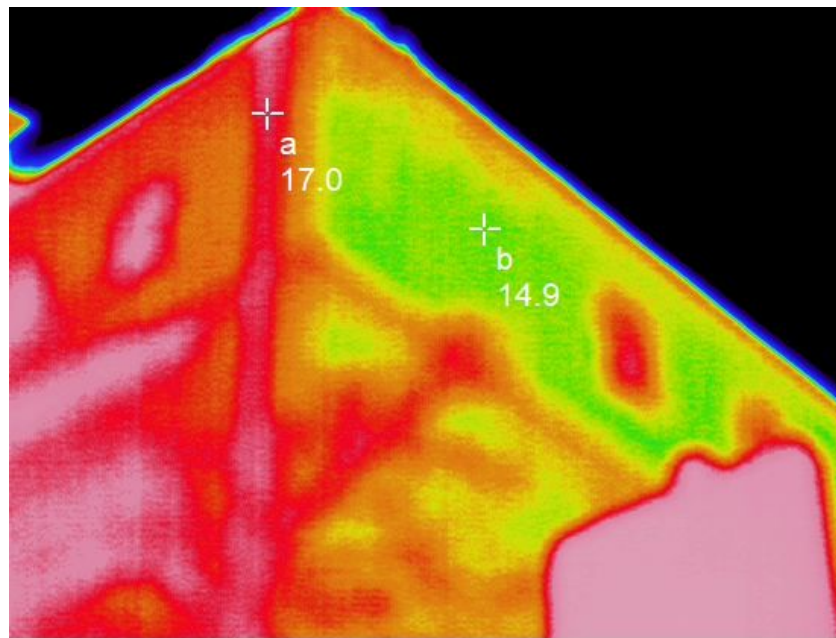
Imagen termografica fachada Norte (derecha) fachada Este (izquierda)(Fuente: Elaboración propia)
